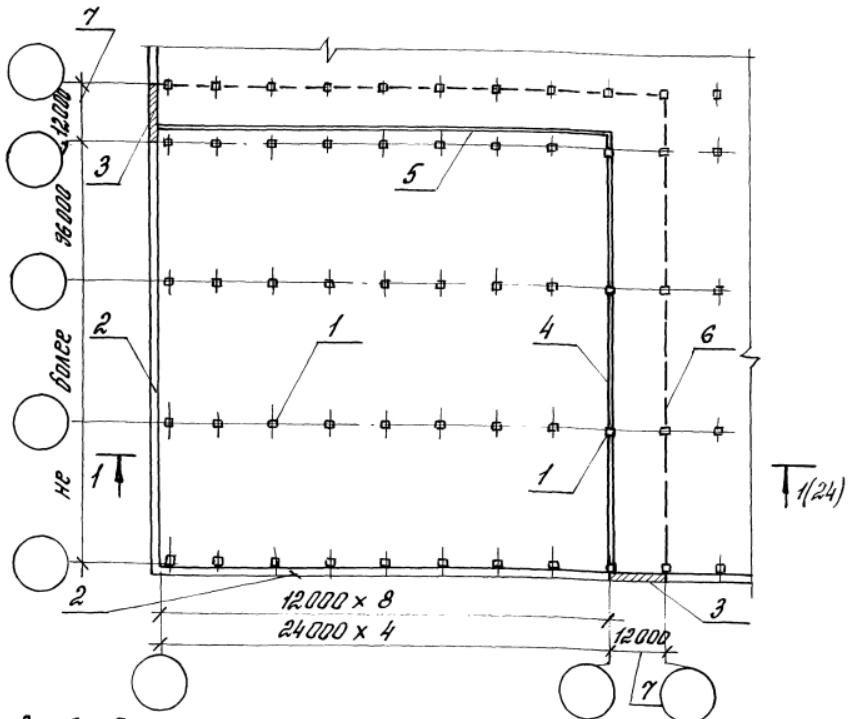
Пример расположения противопожарных перегородок и диафрагм в составе противопожарного пояса, разделяющего конструкции покрытия и стен из горючих и трудногорючих материалов
